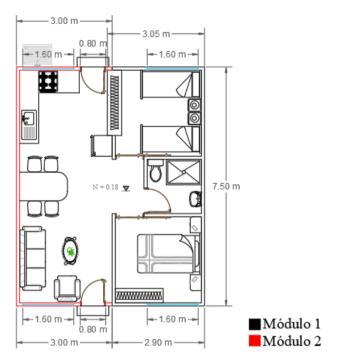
Mobiliario de la vivienda mínima modular planta baja.
